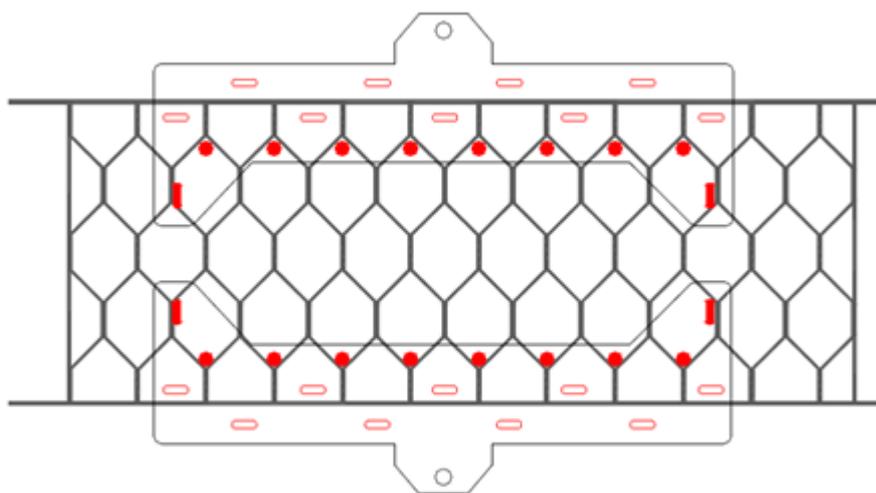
Общий вид рамы для закрепления образцов сетки проволочной крученой для габрионных конструкций
